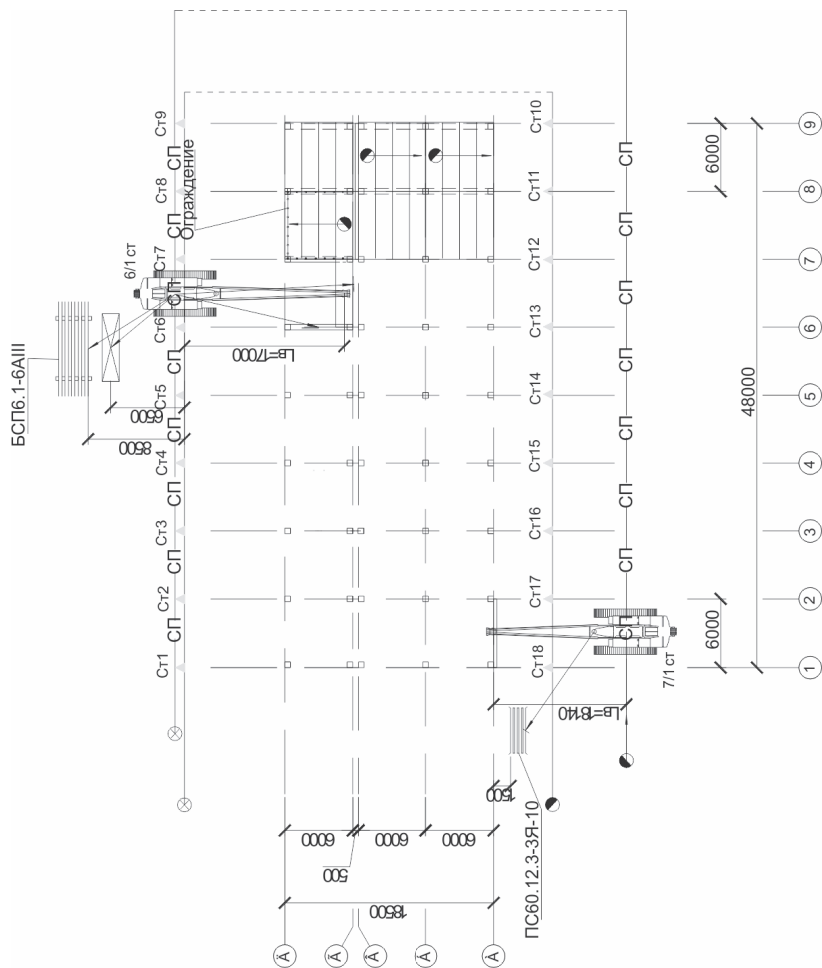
Схема монтажа элементов покрытия, выполнена А.А. Семиволоковой, гр. ПГС-09-1
